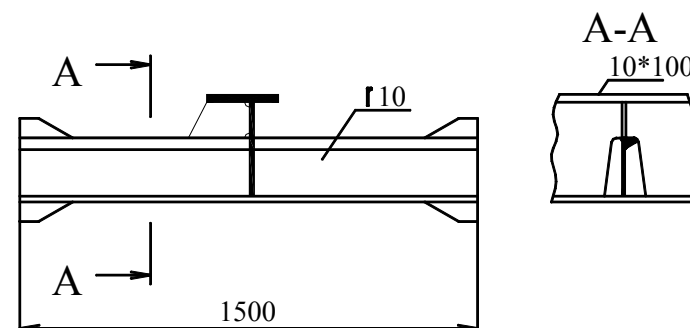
Опытная конструкция балки с узлом её пересечения с поперечной связью.
